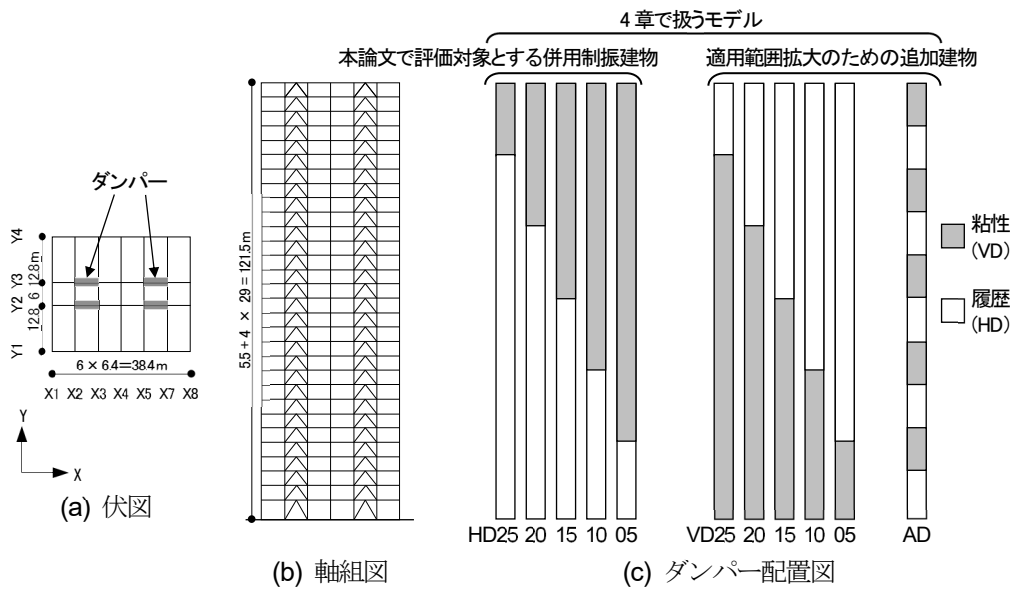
対象制振建物の伏図，軸組図，ダンパー配置図
